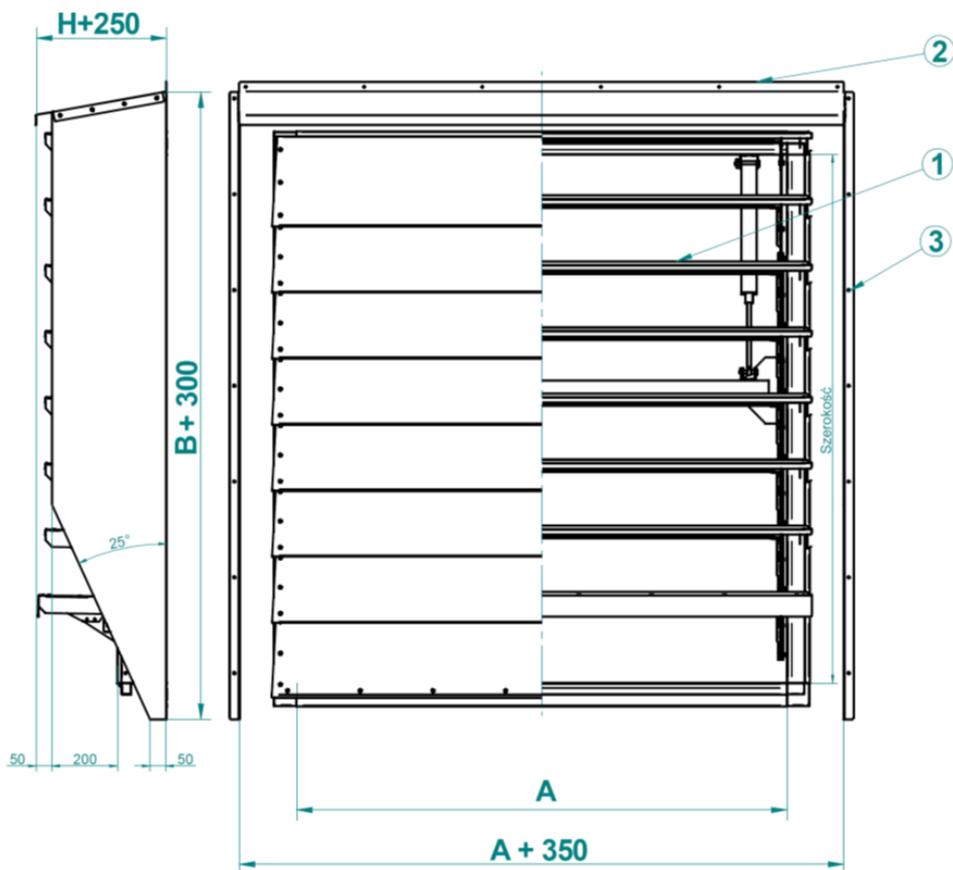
Стандартная конструкция дымового люка mcg LAM.
